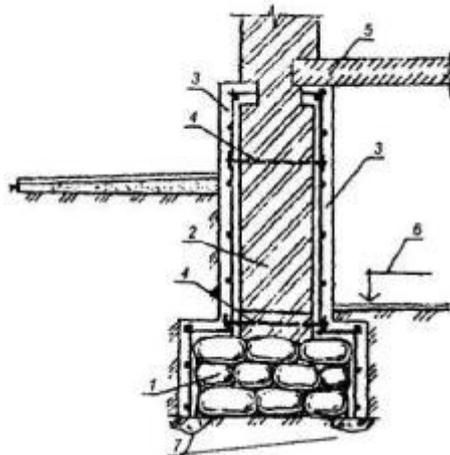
1 - усиливаемый бутовый фундамент; 2 - усиливаемая кирпичная стена; 3 - железобетонная обойма; 4 - анкеры; 5 - надподвальное перекрытие; 6 - отметка пола подвала; 7 - зона обжатого грунта основания.
